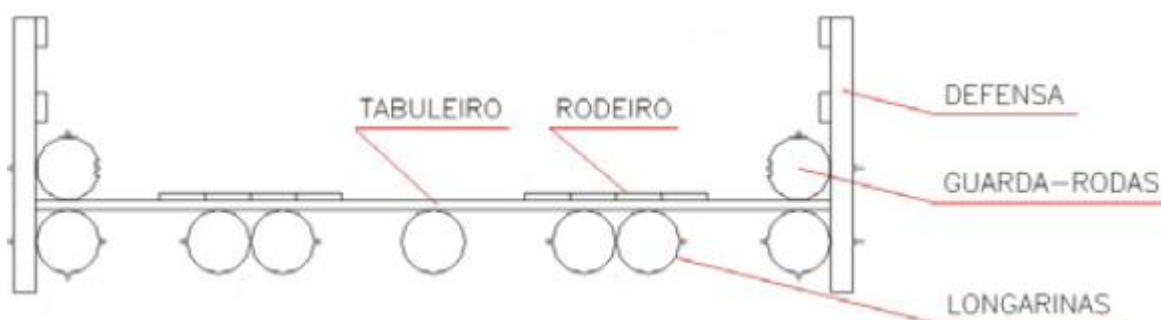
Seção transversal dos elementos comumente encontrado nas pontes de madeira em vigas roliças
